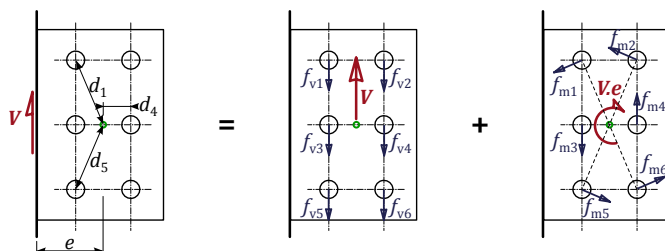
Assemblage d'une poutre par gousset soudé
